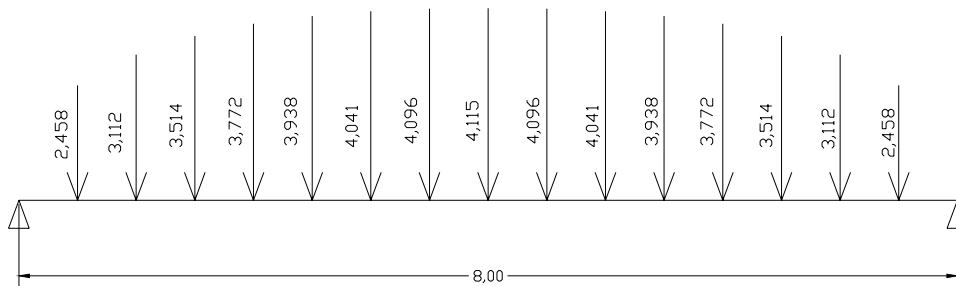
Reações, em kN, na viga VR1 do pavimento PR3
